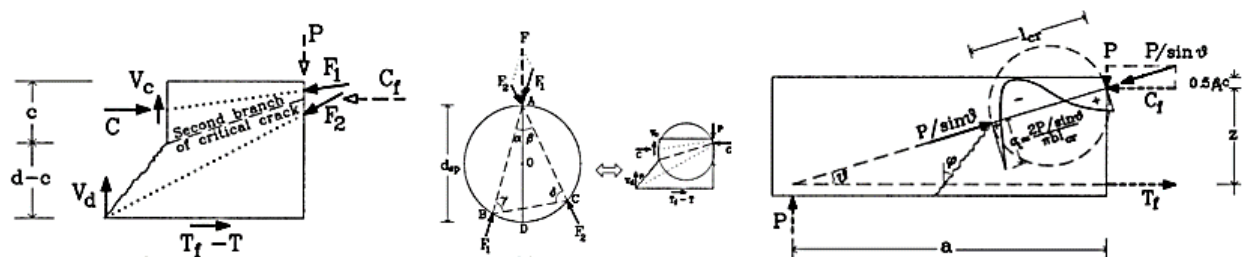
a) Representación de las ramas críticas de fisura en vigas de hormigón. b y c) Símil entre las tensiones en la cabeza de compresión y ensayo brasileño [24].
